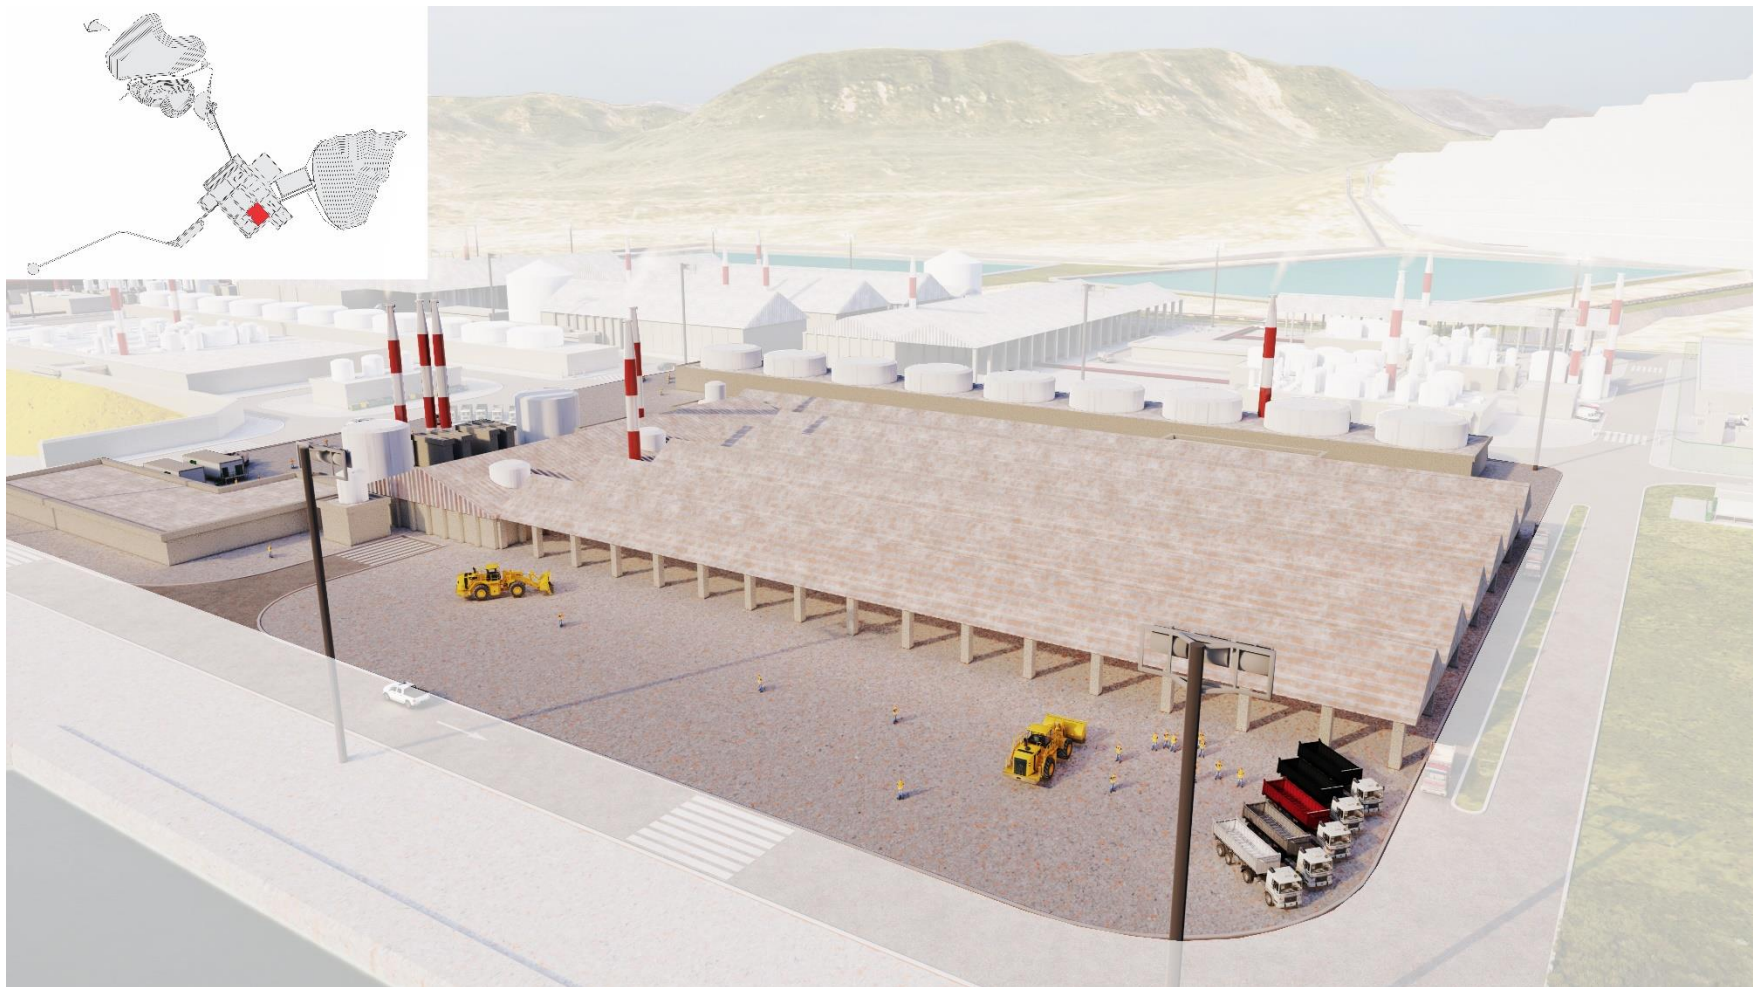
Vista da Planta de Fosfato Bicálcico
